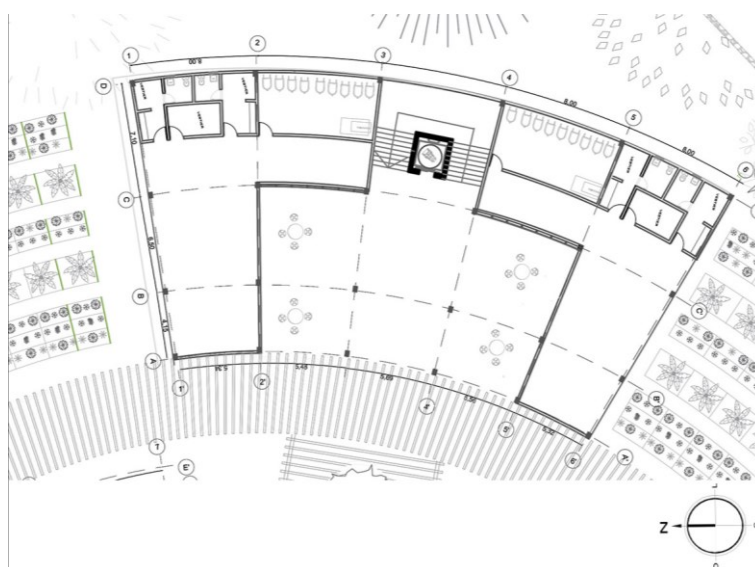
Planta 1er piso bloque Técnico y Tecnológico. Fuente: Elaboración propia.
